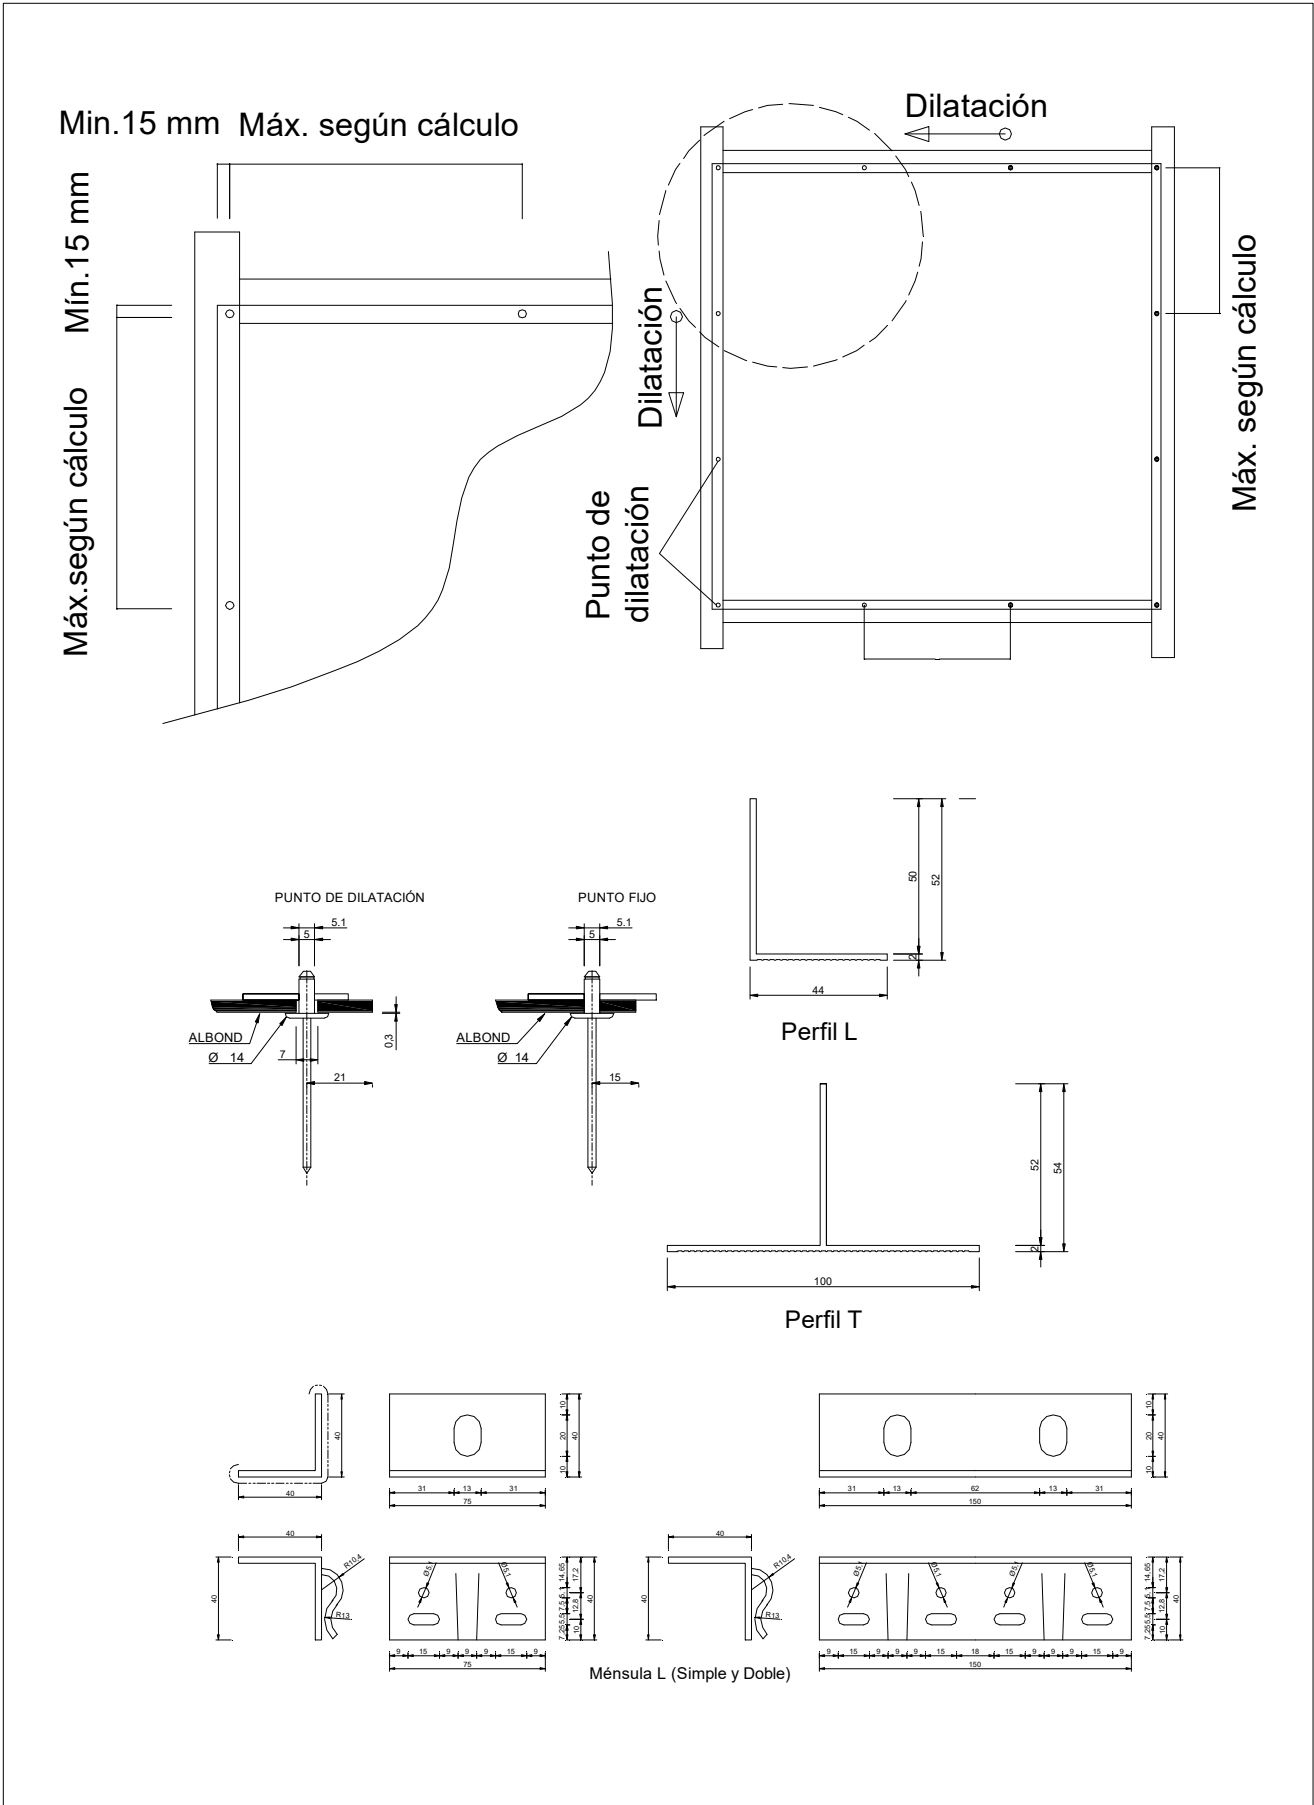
Detalles de formación de aplacado (arriba) y de componente de subestructura (abajo)
